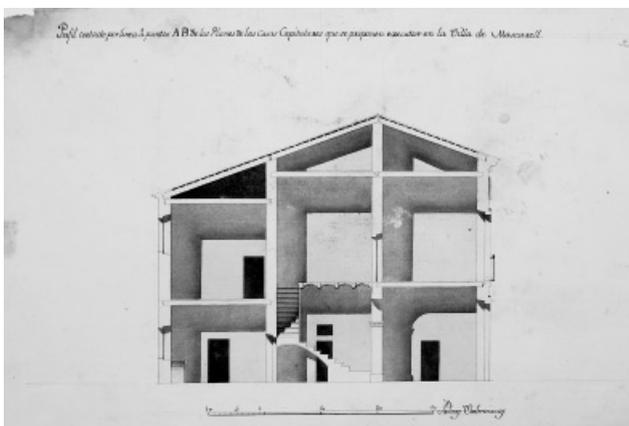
Plano sección de Casas Capitulares del arquitecto Vicente Gascó
